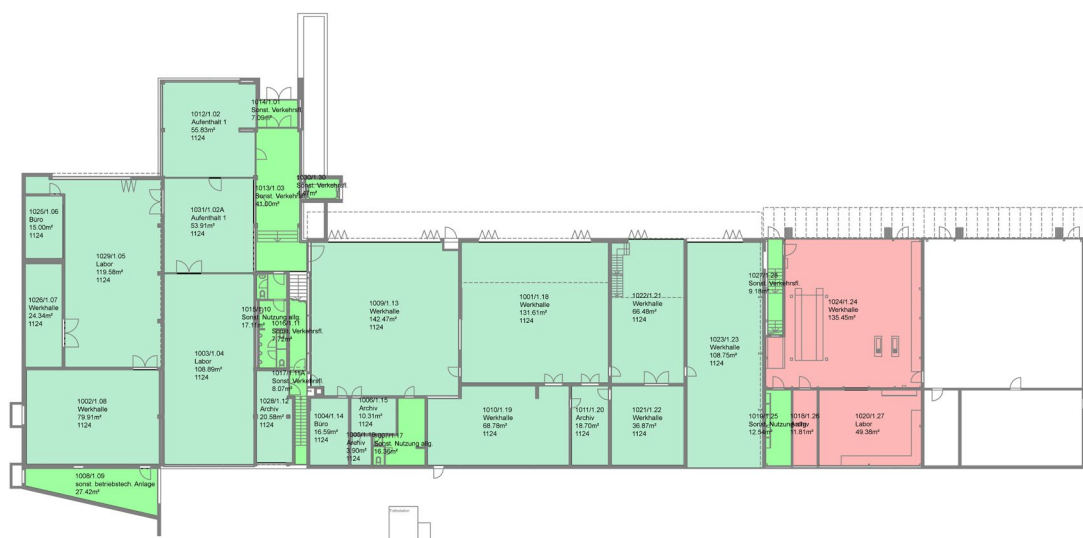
Grundriss Vauffelin EG (grün BFH - rot DTC)
